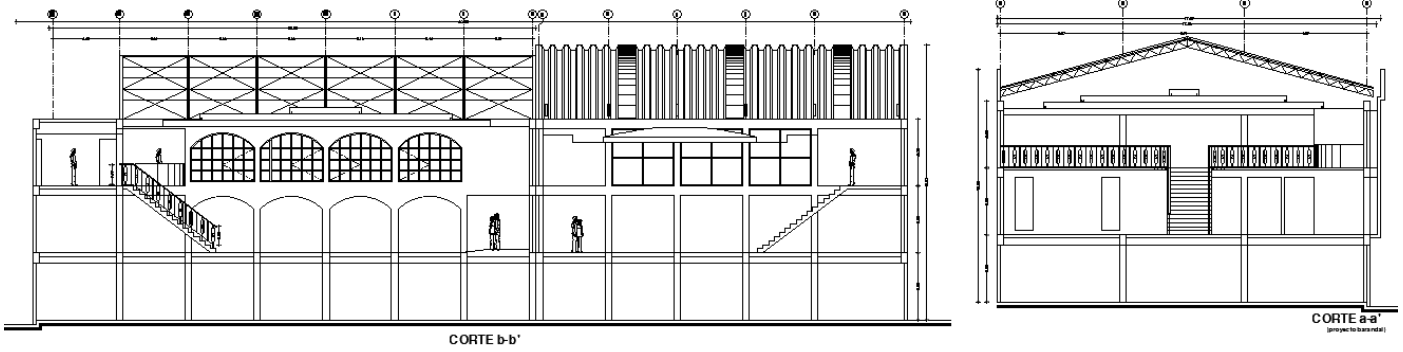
Cortes longitudinal y transversal donde se aprecia el proyecto de fachadas interiores de ambos salones. Autoría propia
